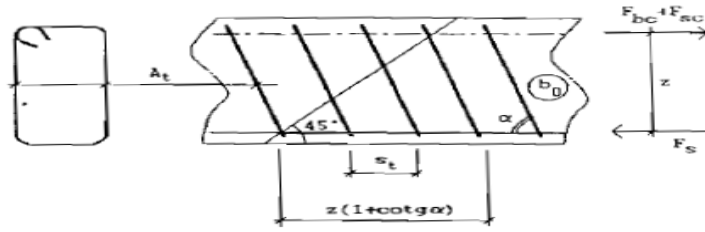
Couture de la fissure du béton par les armatures d'âmes [1]
